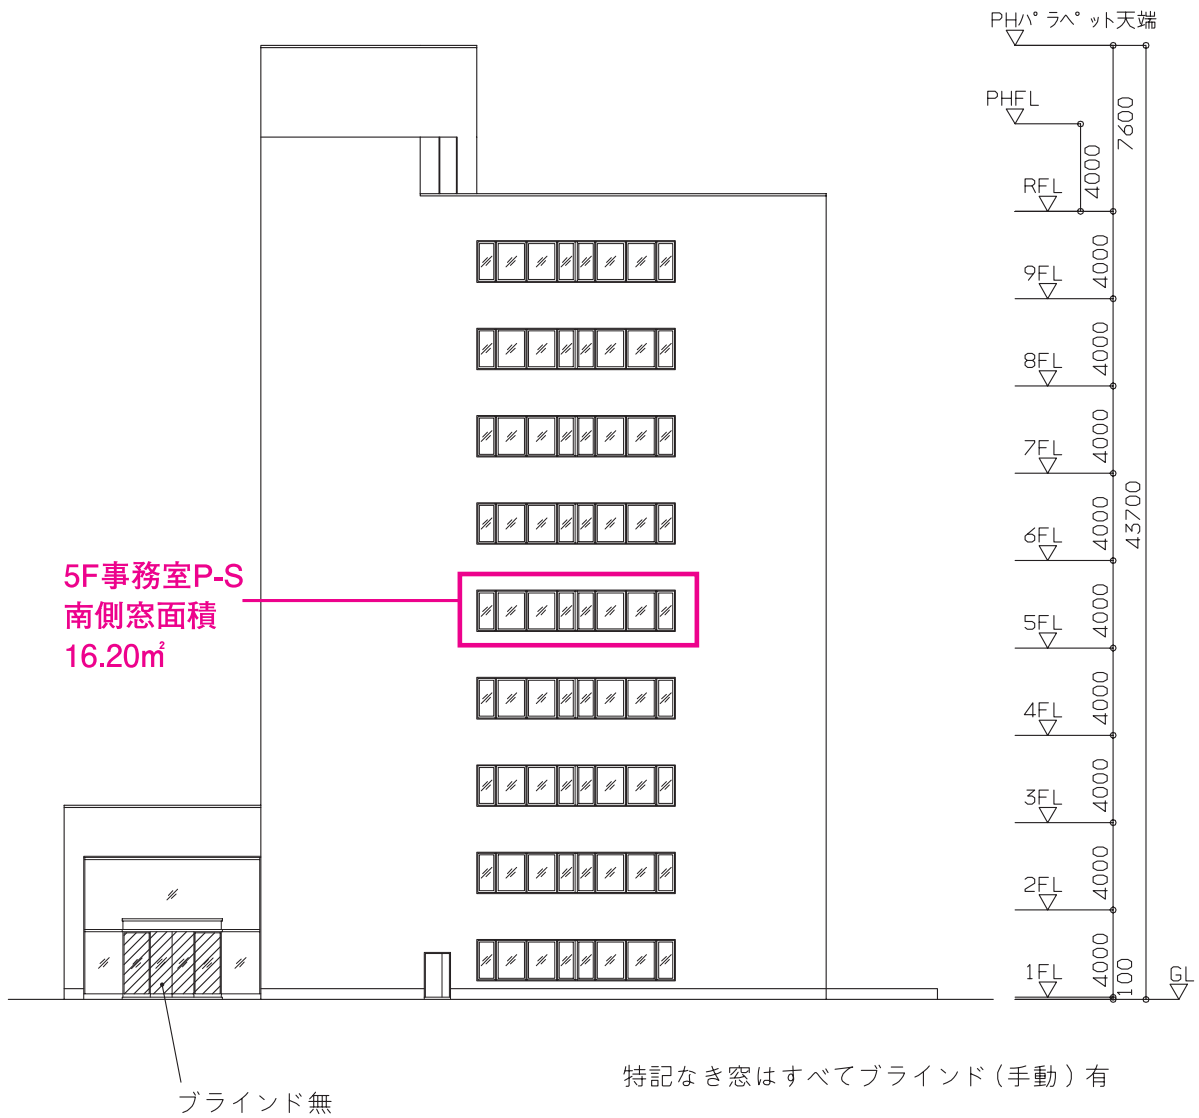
意匠図 立面図（南）（図面 - 意 - 9）
